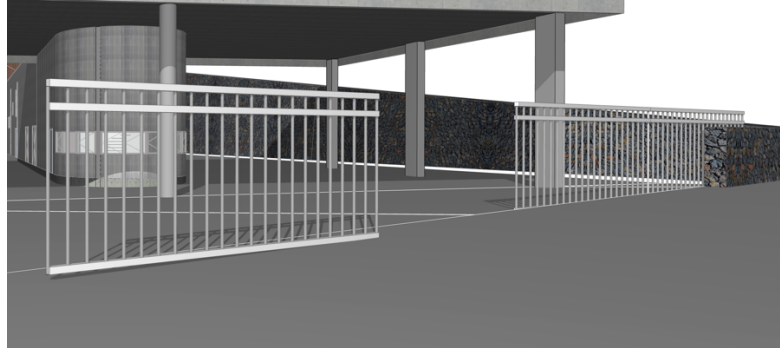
Portón de acceso al perímetro del edificio. Fuente: Elaboración propia.
